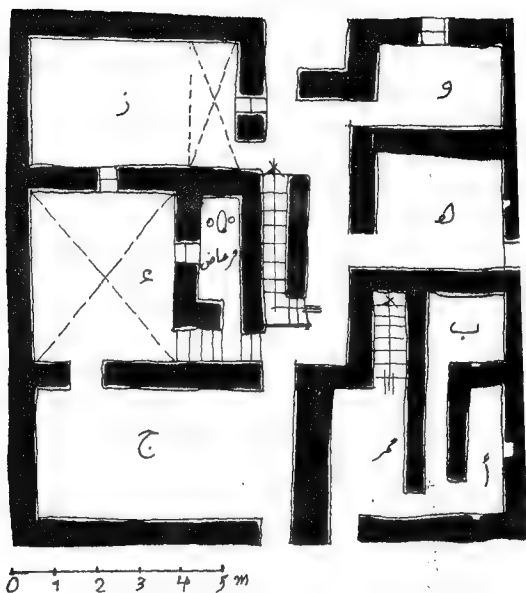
منزل مهدي عراصة الطور الأول - مسقط النقي.
